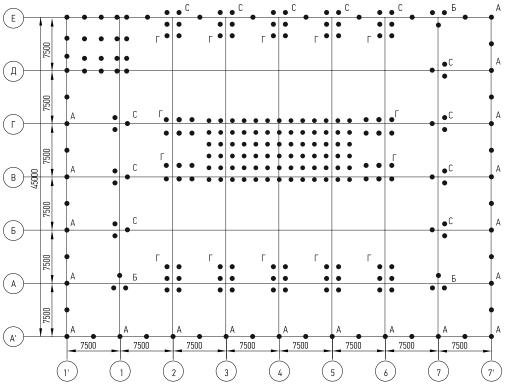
Схема расположения свай при варианте монолитного железобетонного каркаса с сеткой 7,5х15 м
